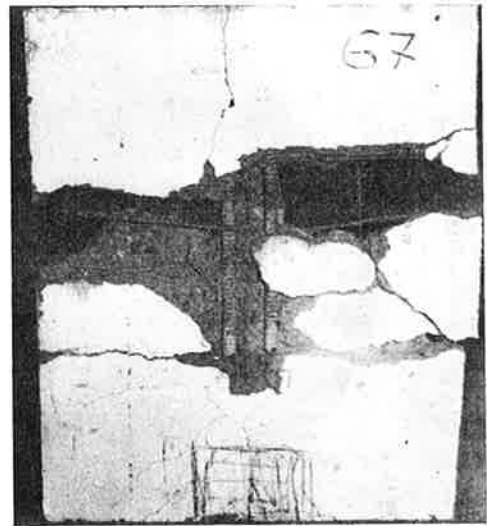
c. Brottfigur för element av typ R (utan byglar). Flänsen har dragits av i samband med att flänsarmeringen glidit i betongen ovan upplaget. • *Fracture pattern. Type R element (without stirrups). The flange was pulled off in connection with slipping of the reinforcement in the flange above the support.
